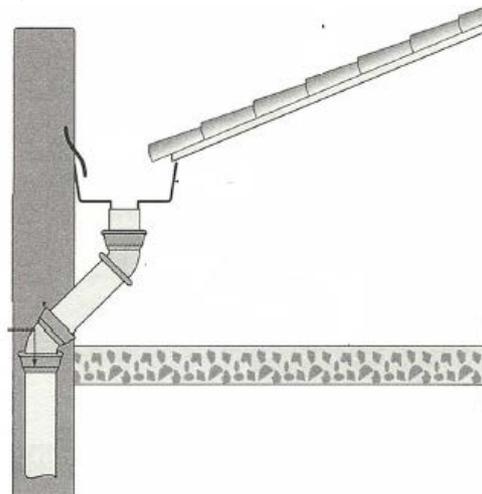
Detalhe da ligação da calha ao condutor vertical
